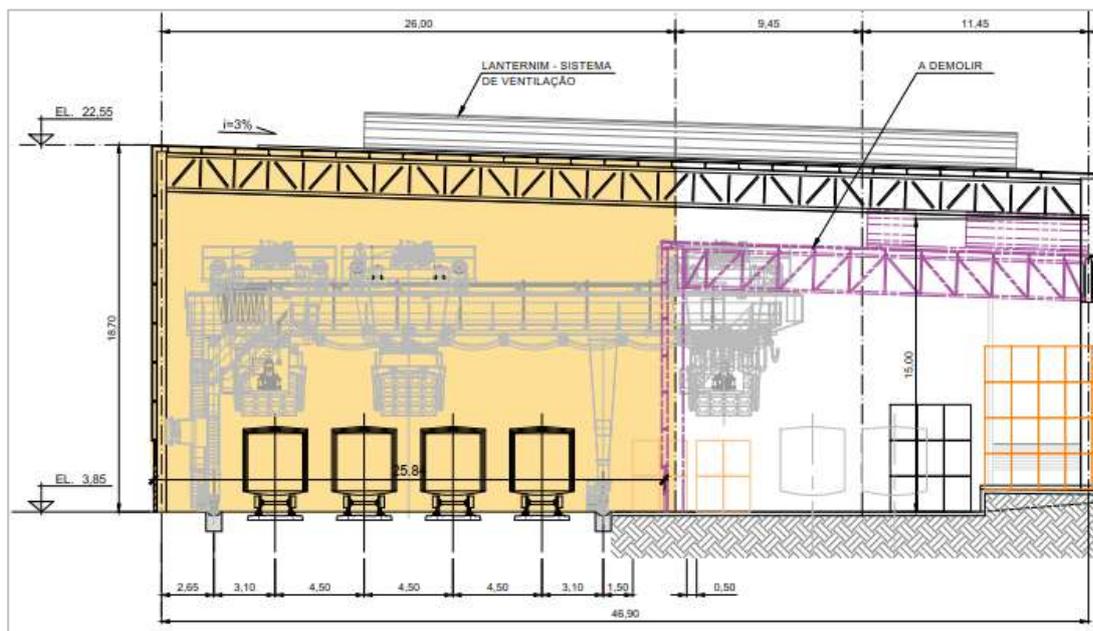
Seção típica da implantação da Fase 2 do terminal.
